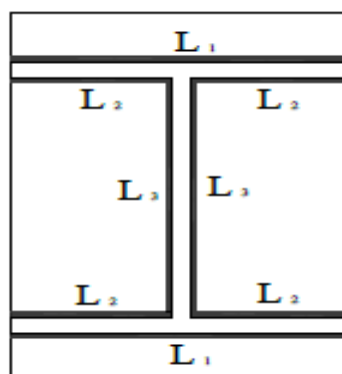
Assemblage soudé poutres – platine.
